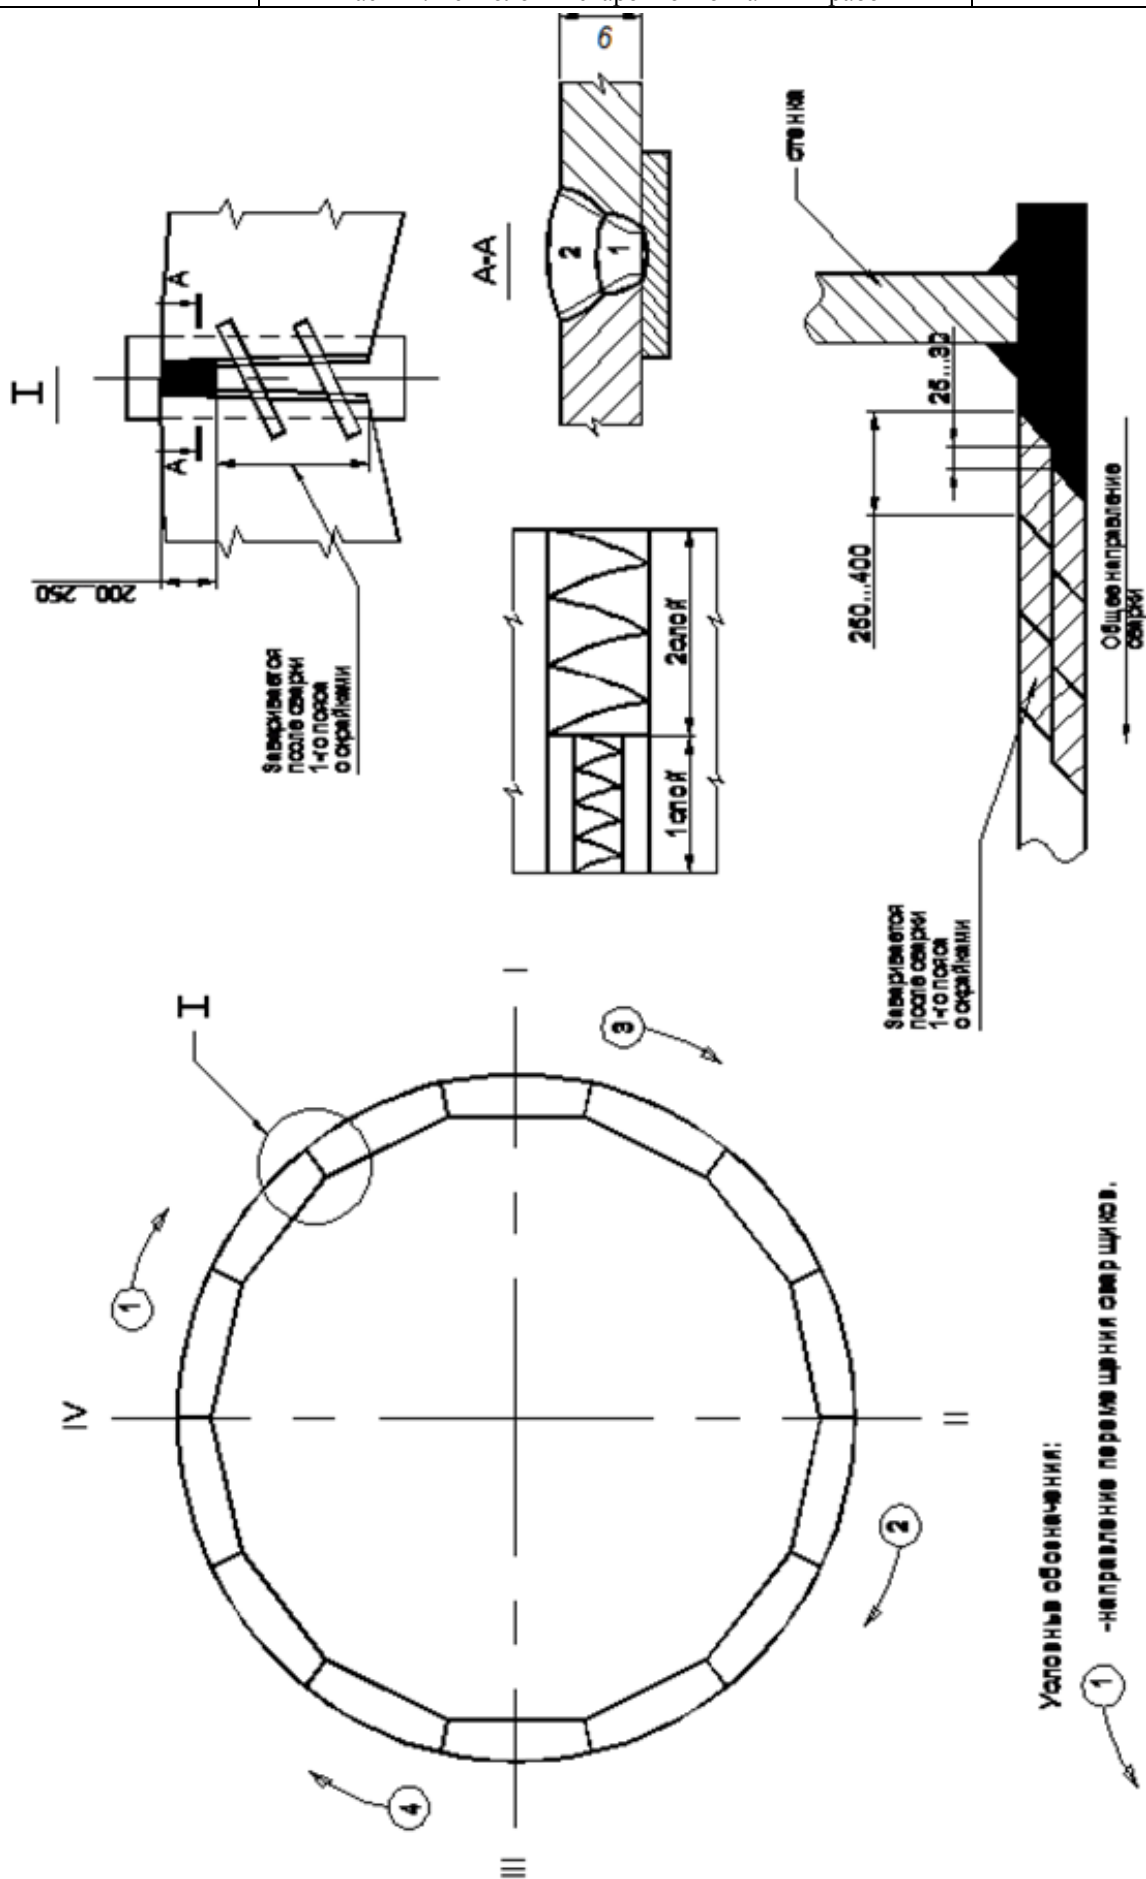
Схема выполнения сварных швов окрасок дна (сварка в два слоя)
